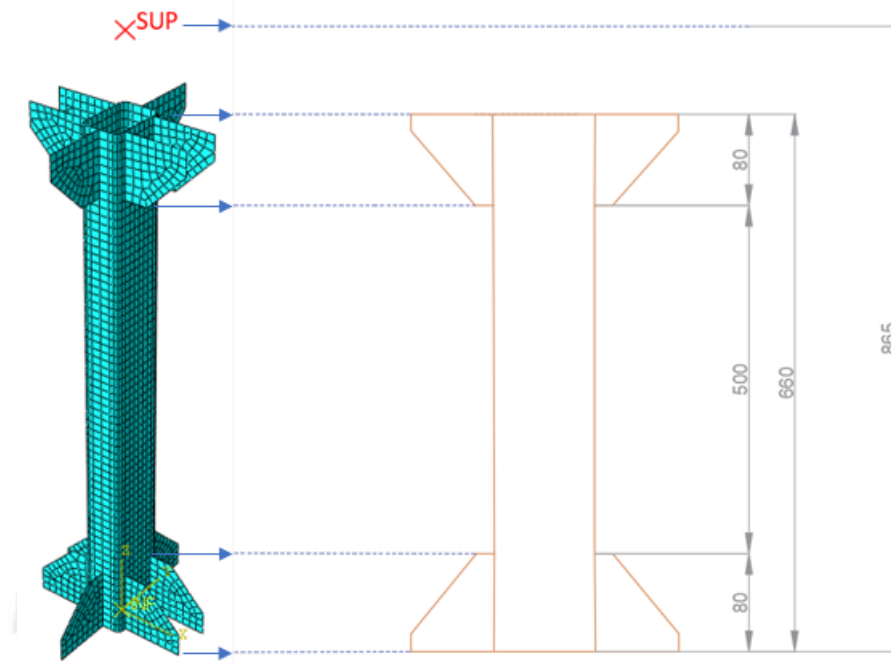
Dimensiones la columna ensayada, medidas en milímetros
